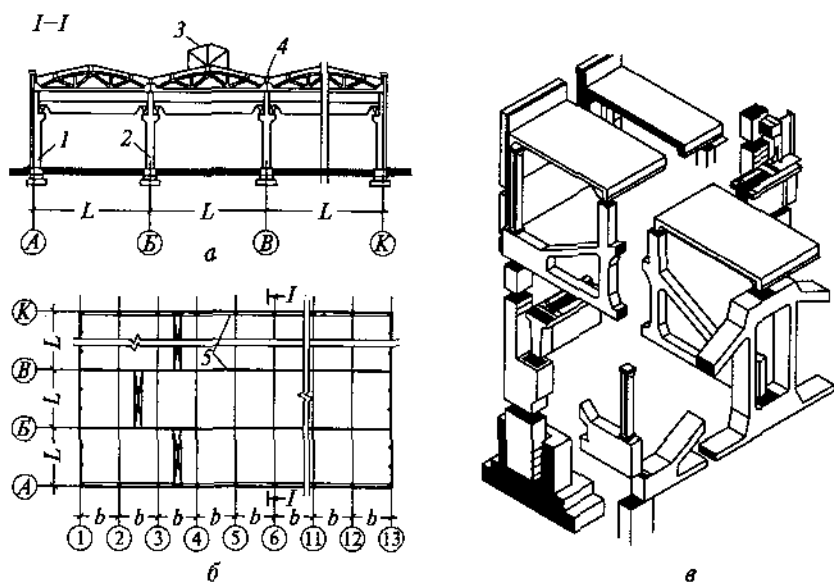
Конструктивно-технологическая схема одноэтажного промздания с железобетонным каркасом:
